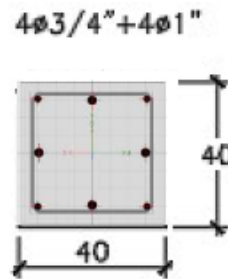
Disposición de la armadura longitudinal en columna C-1
